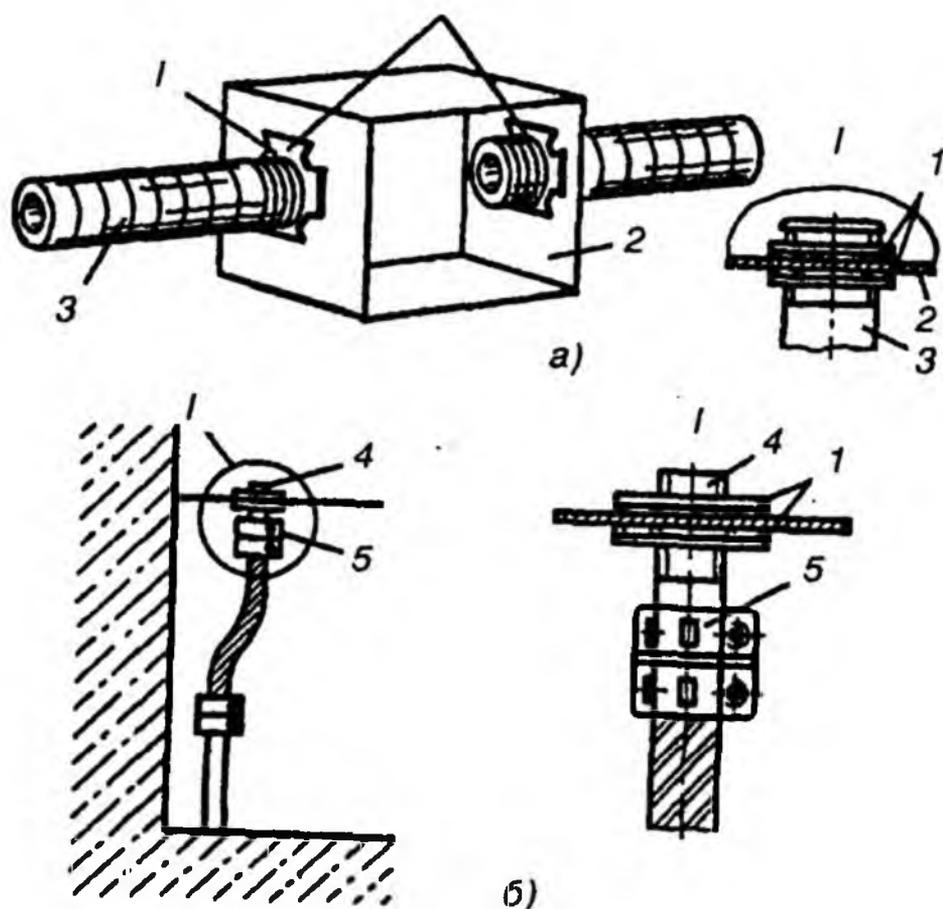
Примеры монтажа электропроводок в трубах:
